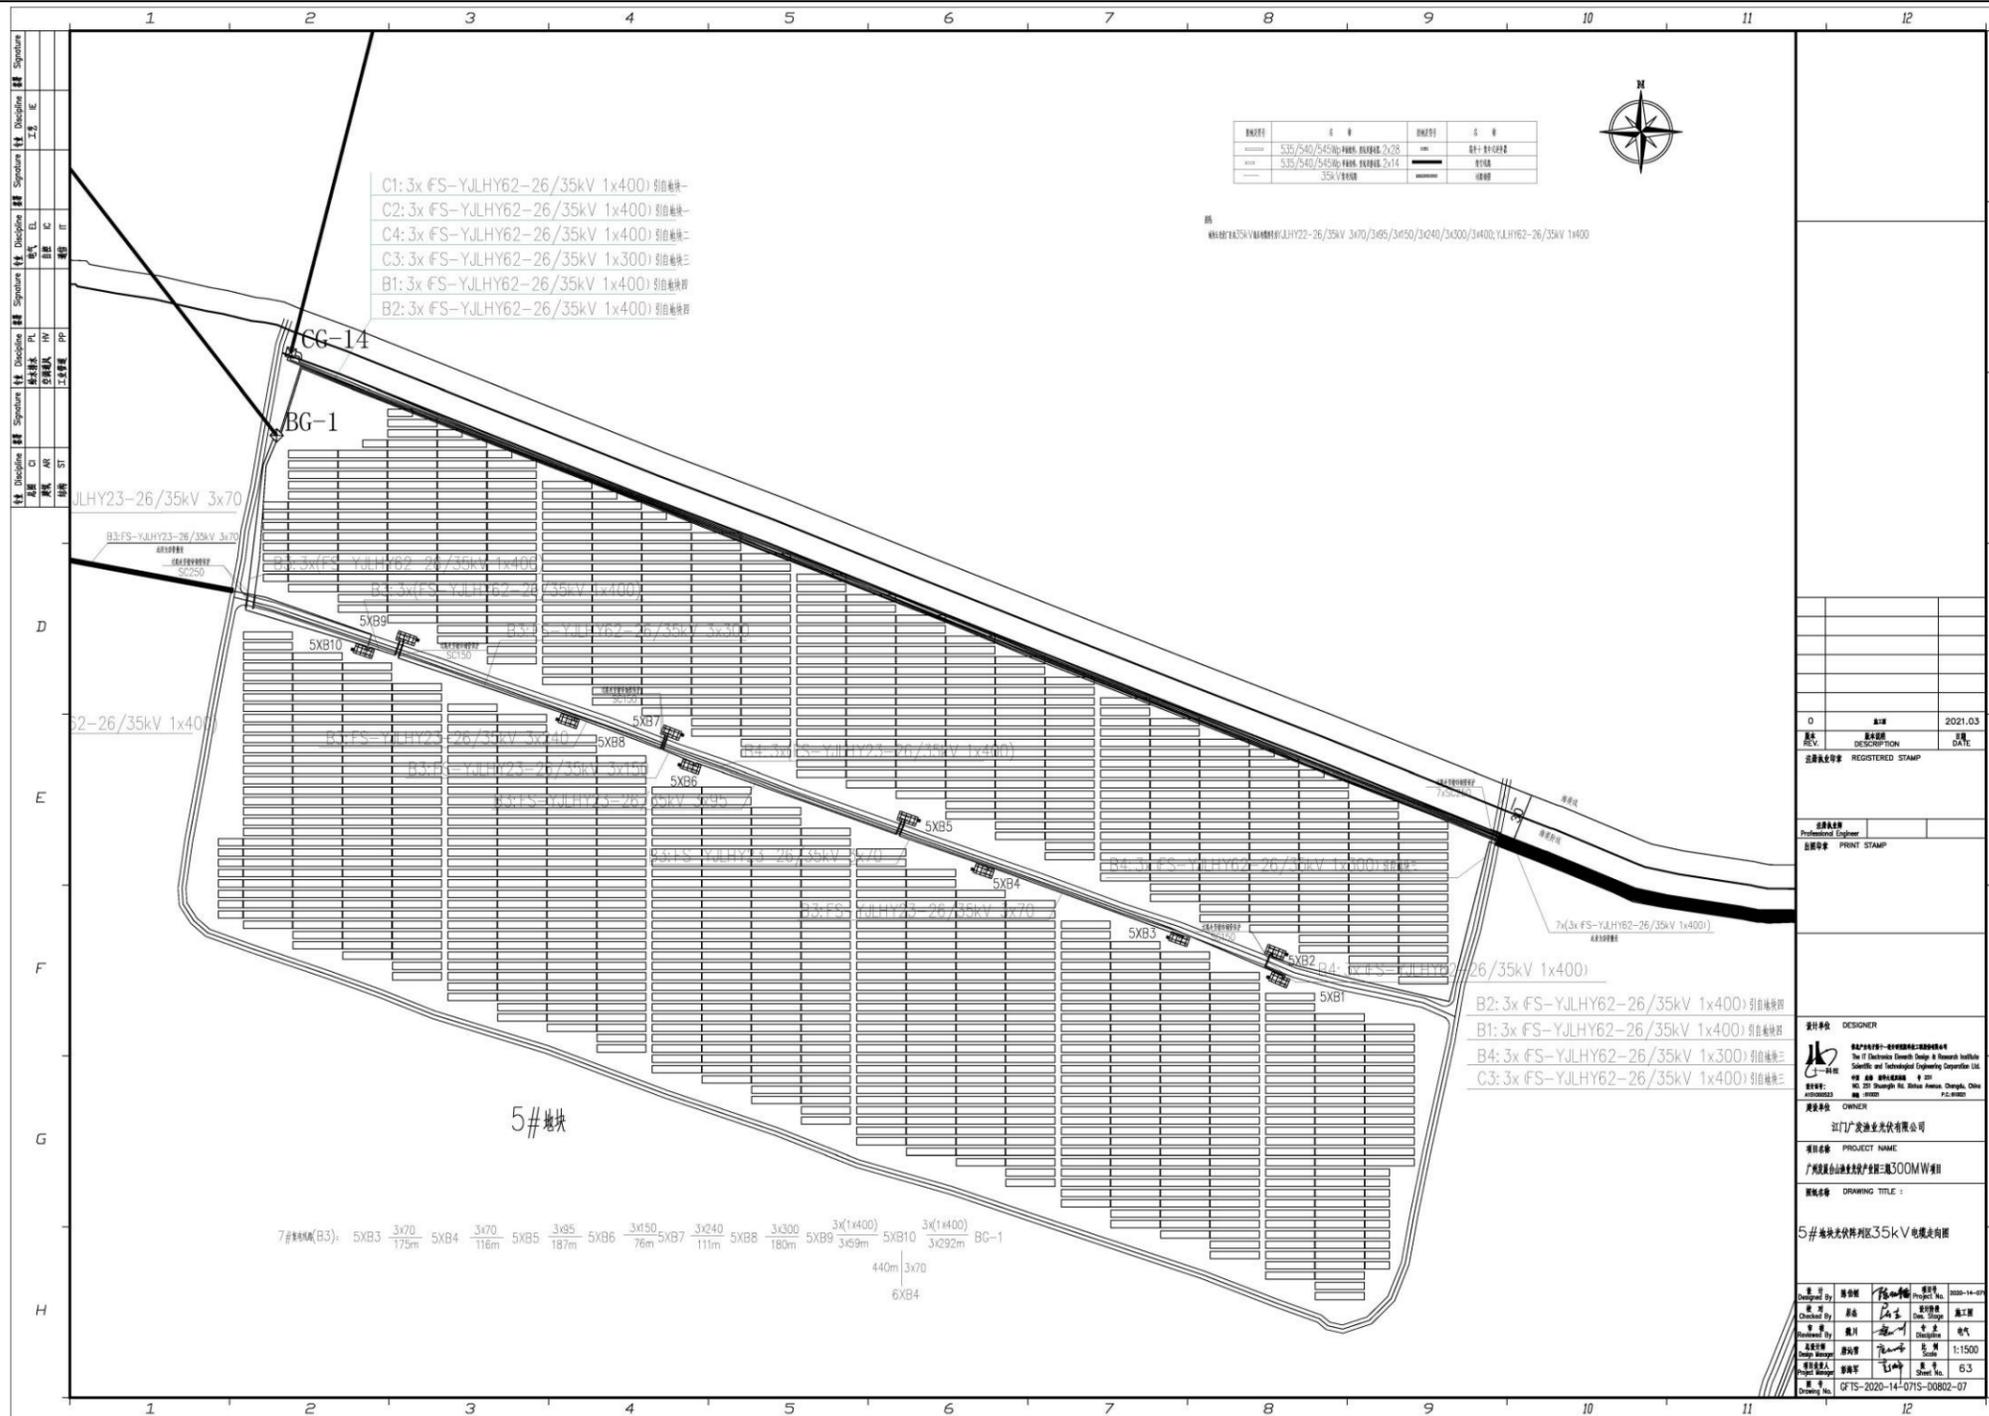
光伏区平面布置图 (A3-A4)
